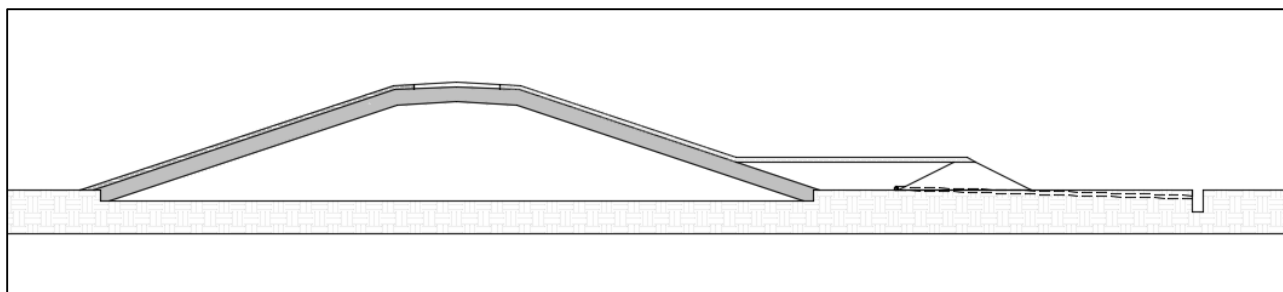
Esquema del perfil transversal del terraplén. Fuente: Elaboración propia
